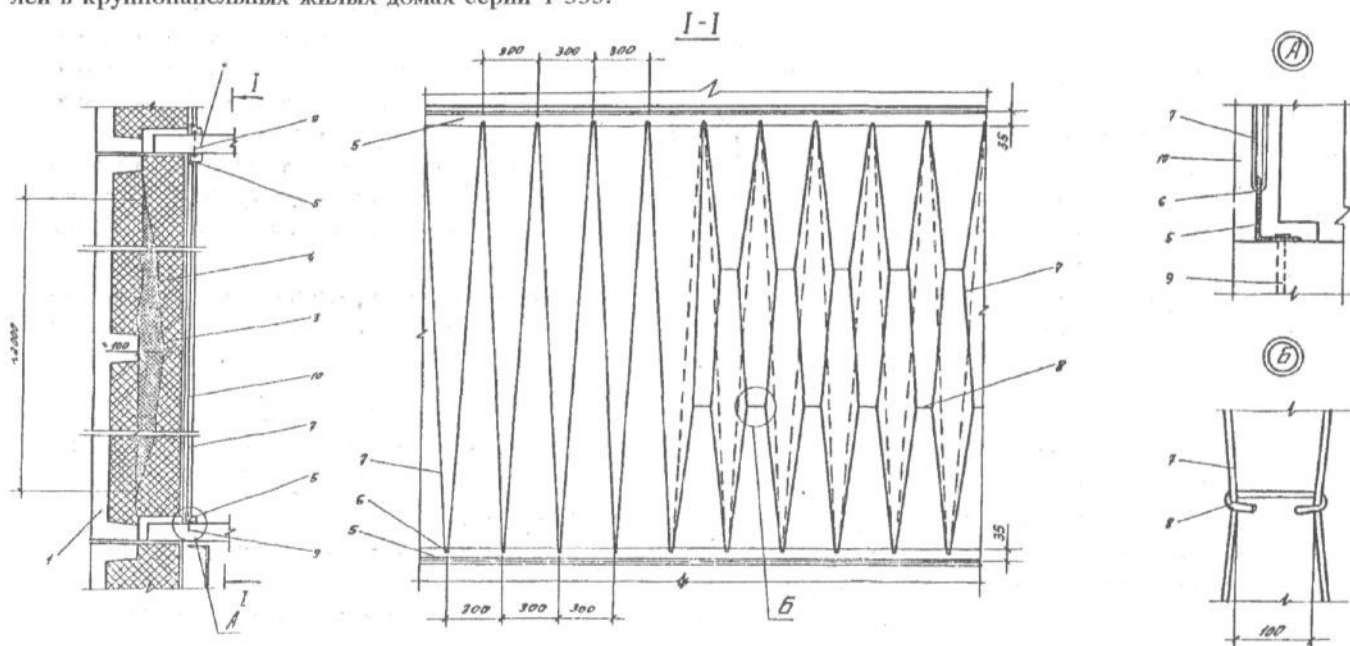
Ремонт утеплителя стеновых панелей.
